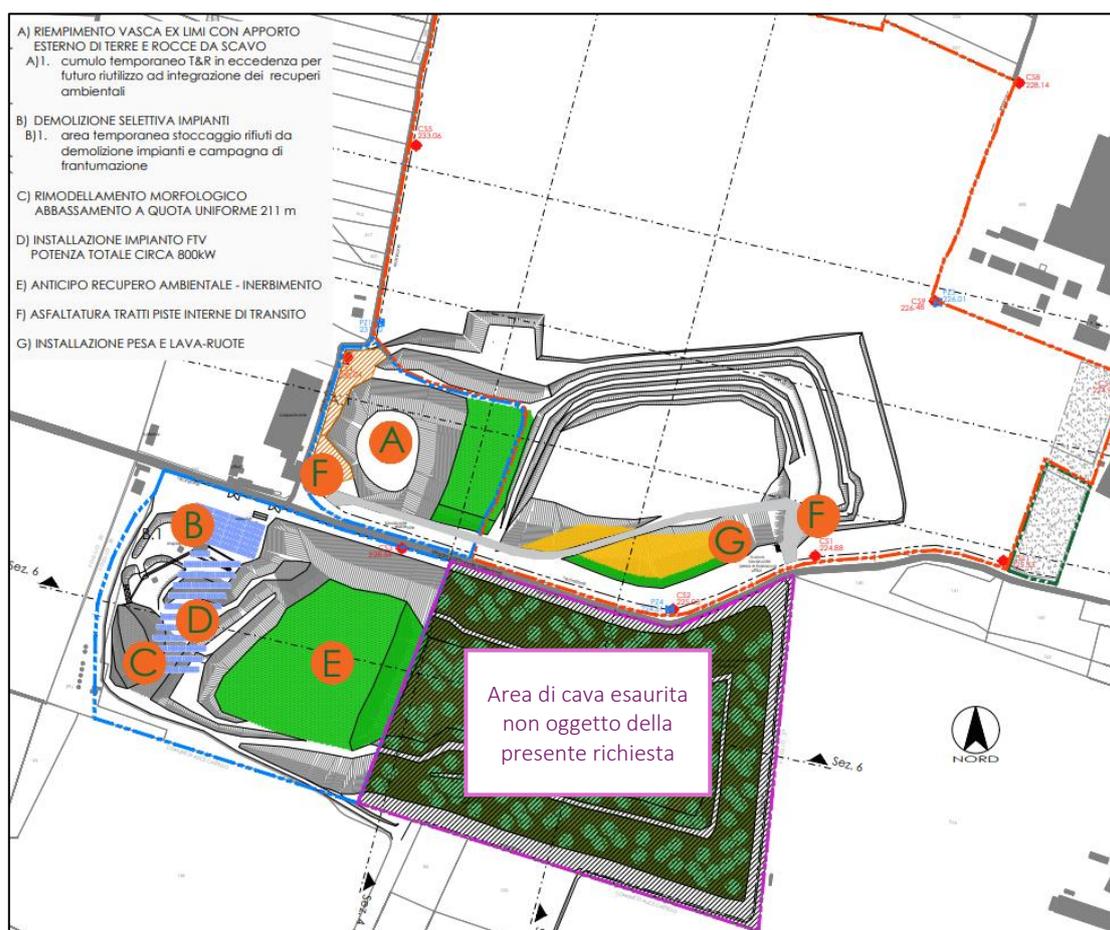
Planimetria nuovo assetto delle aree - Stato di progetto - Tavola 1.9
